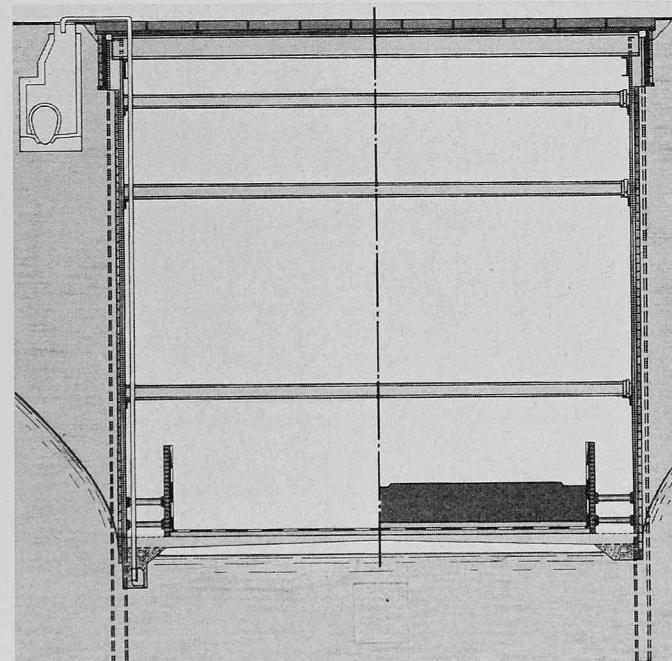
Tunnelbau in abgeböschter Baugrube im Frankfurter Nordweststadt-Zentrum
